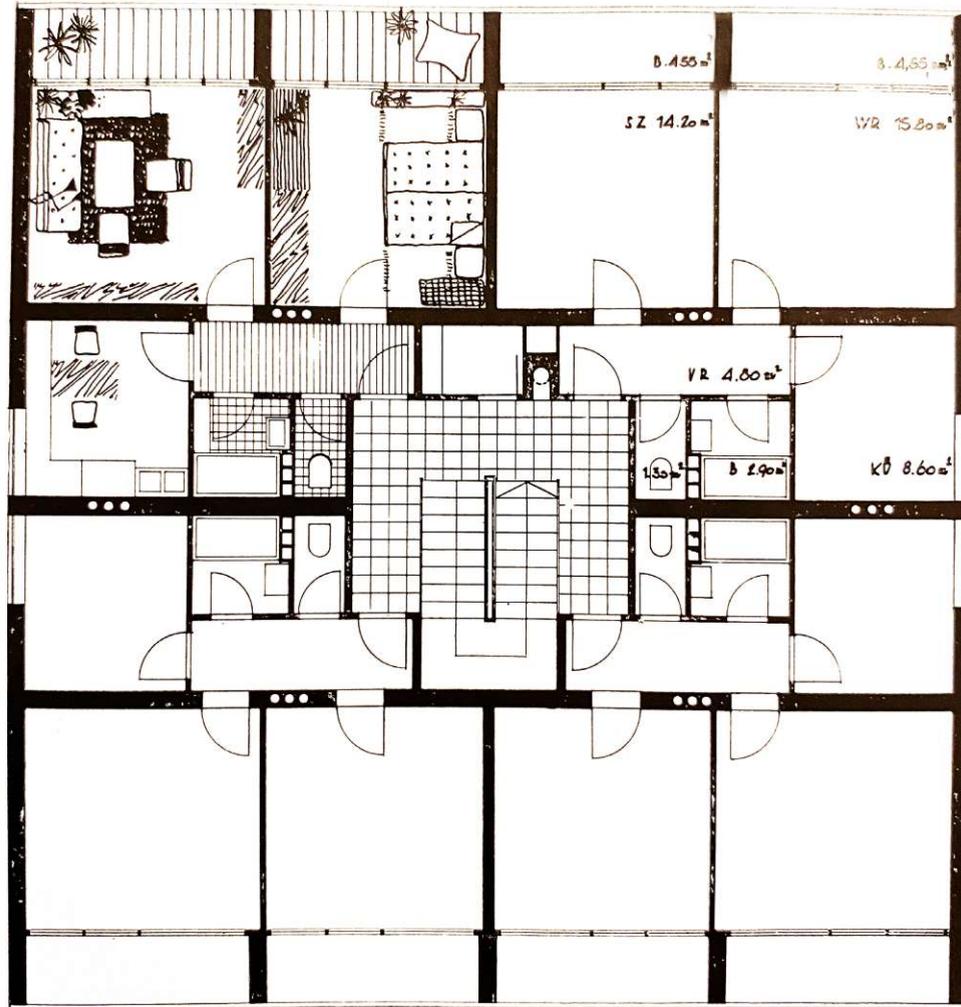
Artur Perotti, Grundrissplan Regelgeschoß Punkthaus, 1959, 2021.
